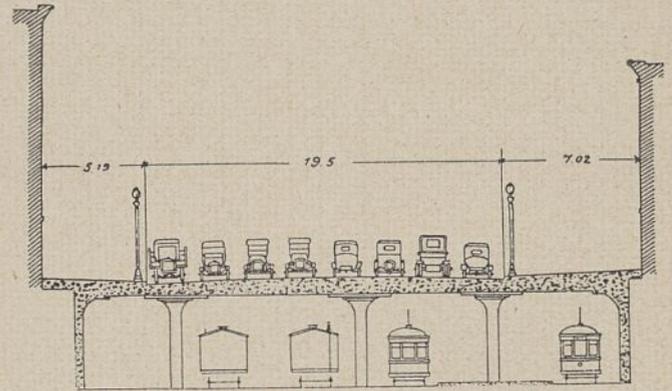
Zweigeschossige Straße in Rochester. Straßenbahn und Lastverkehr im Untergeschoß.
